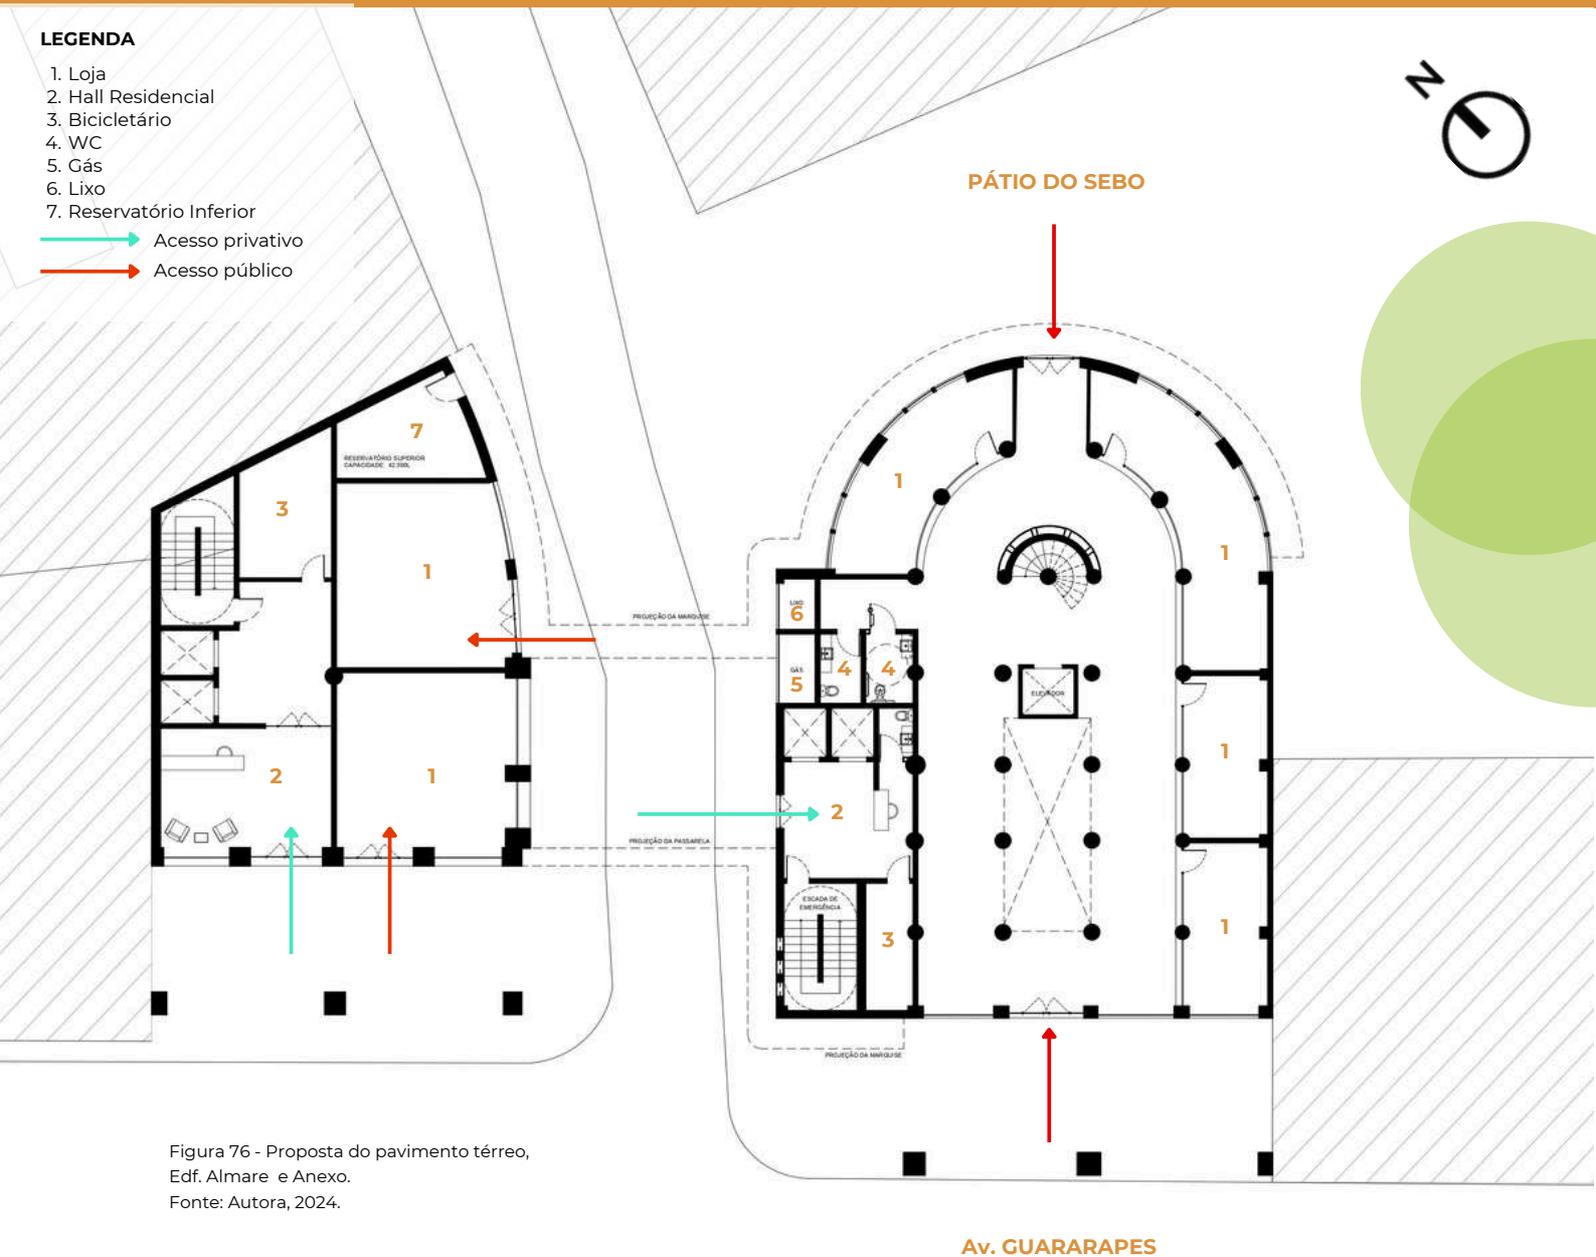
Proposta do pavimento térreo, Edf. Almare e Anexo.
